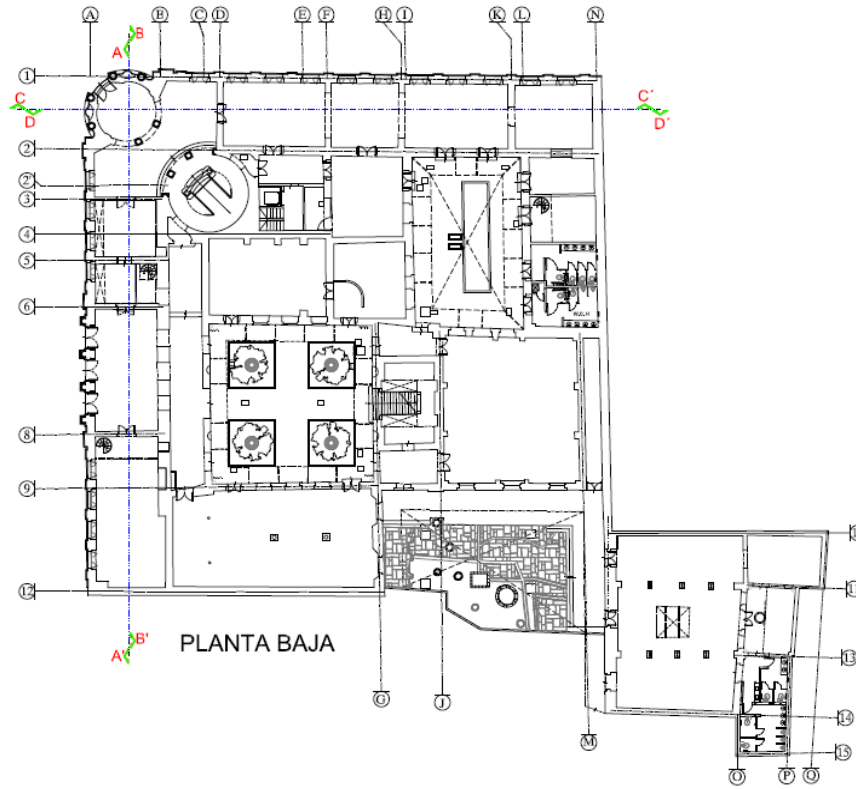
Planta baja del Palacio de la Autonomía (2004) [2.16].
